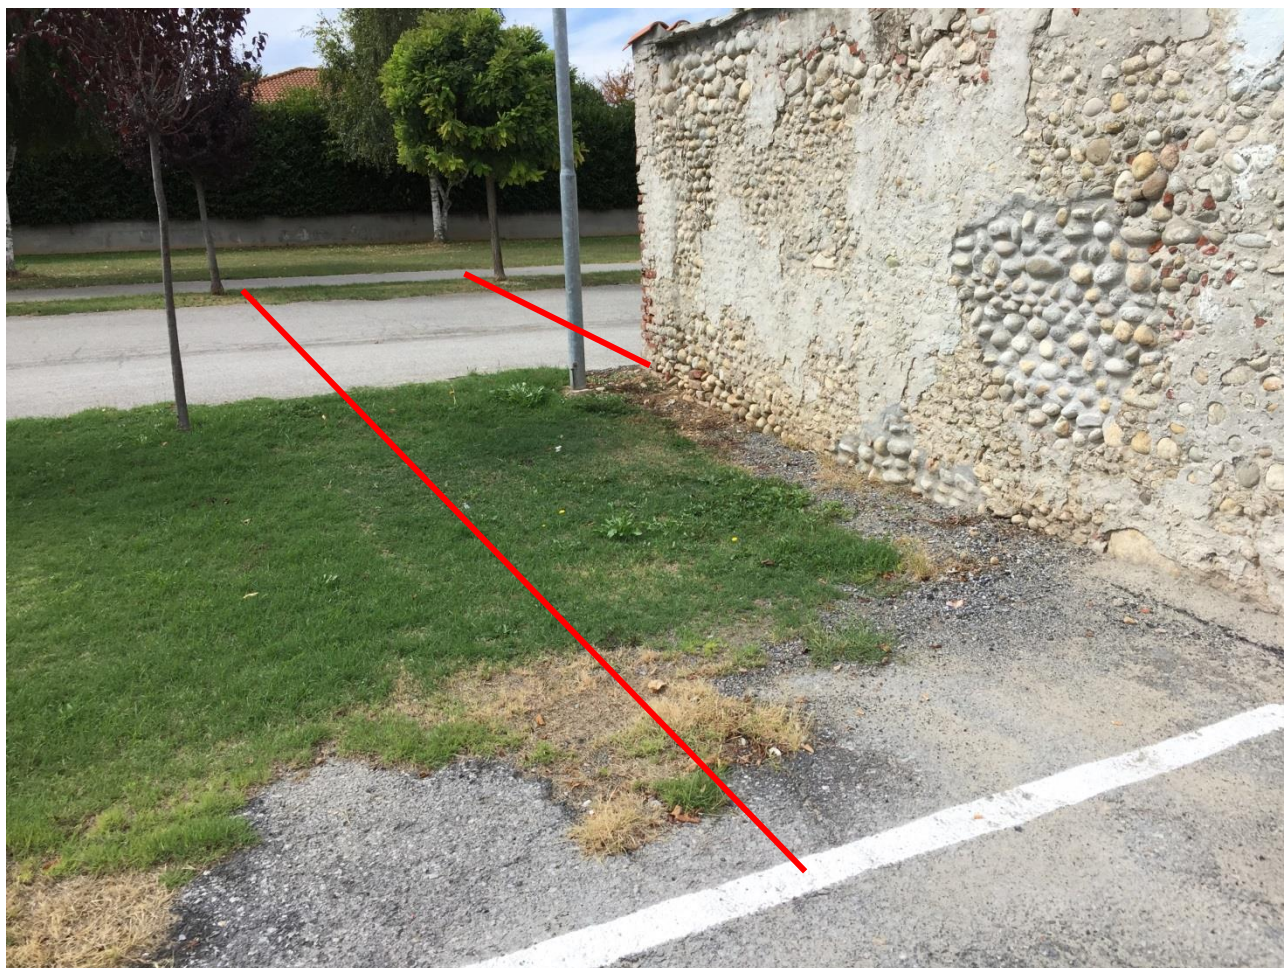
VIALE ROSA, TRATTO NUOVO ATTRAVERSAMENTO PEDONALE
